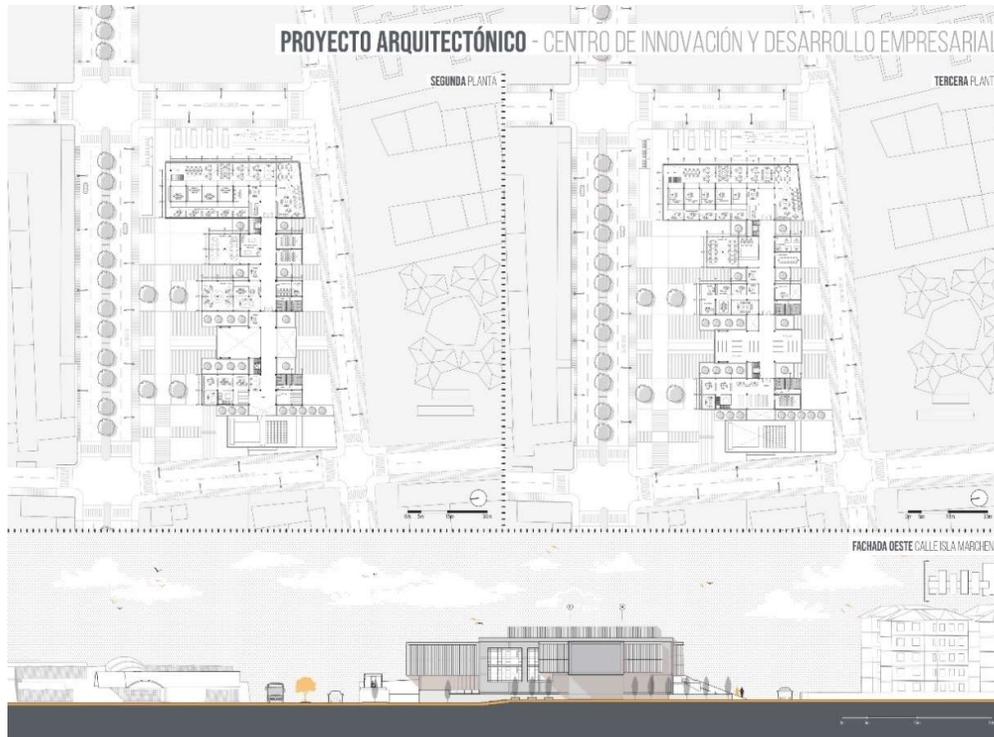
Segunda planta, Tercera planta y Fachada oeste. Elaborado por: Andrés
